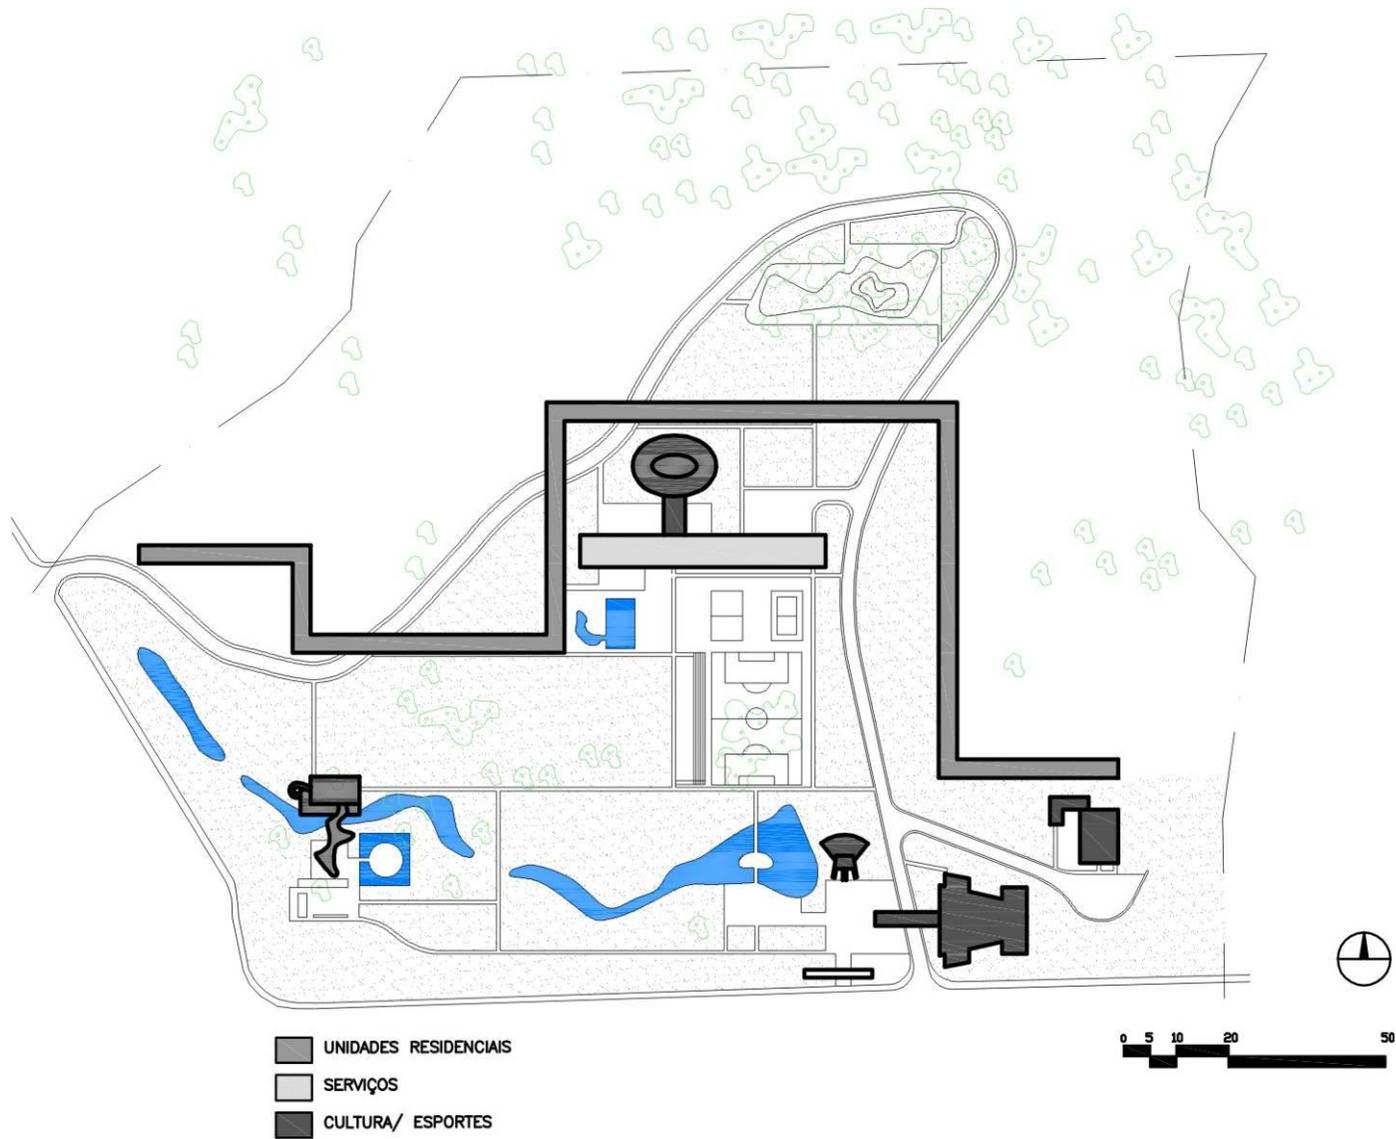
Plantas de situação do Conjunto Residencial Vila Isabel.
